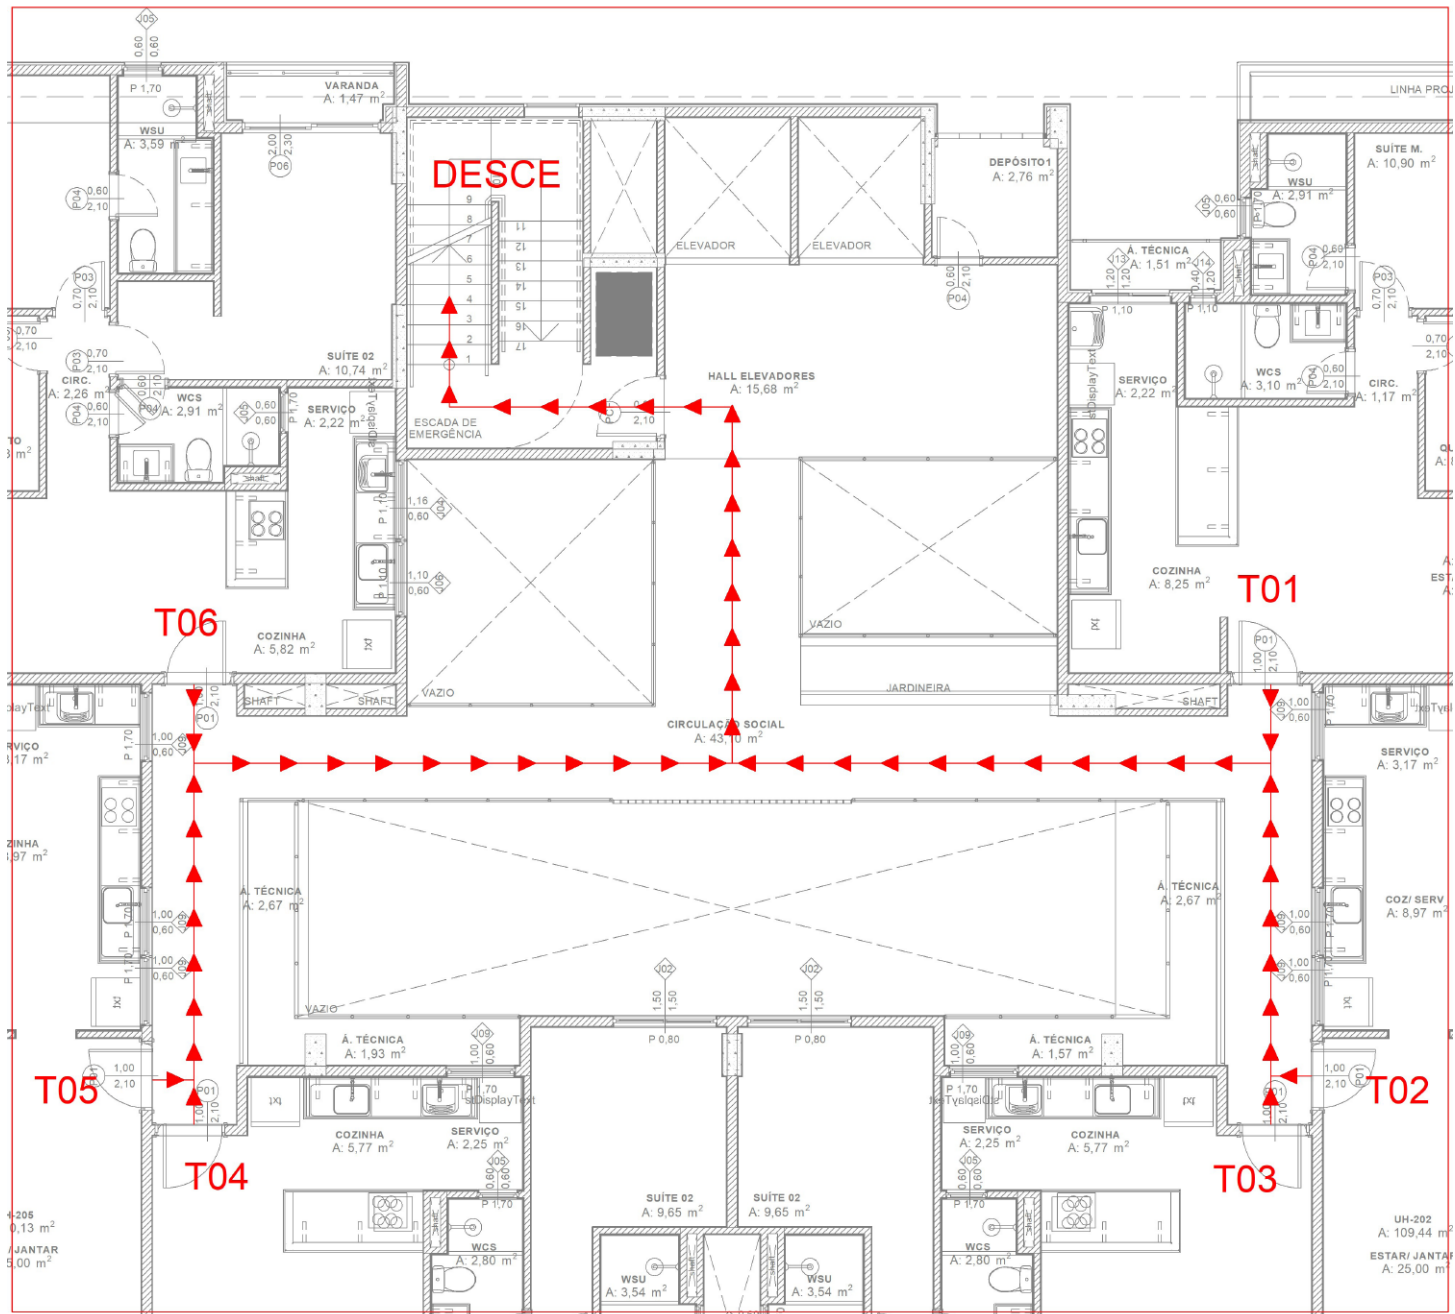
Planta com rotas de fuga do pavimento Tipo (setas em vermelho)
